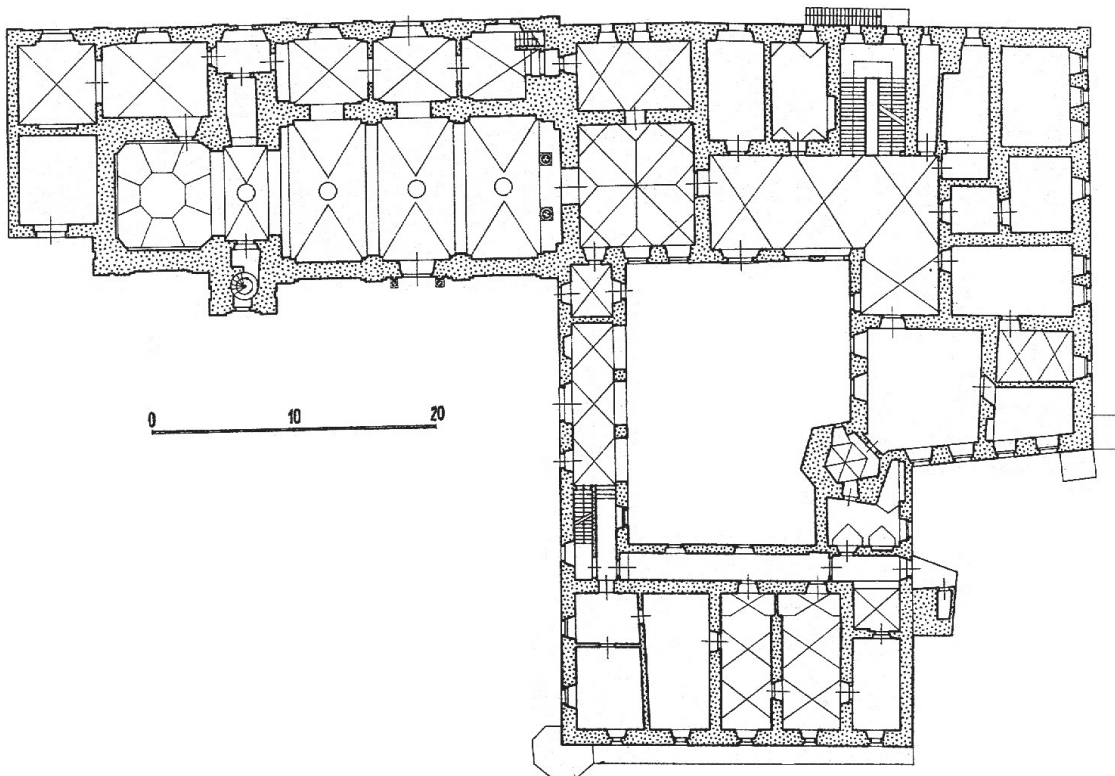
Žiřeč, Jesuitenkirche, Grundriß
